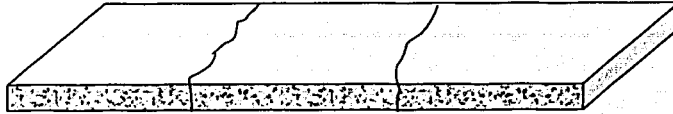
Agrietamiento inicial del concreto sin el uso de pasajuntas
